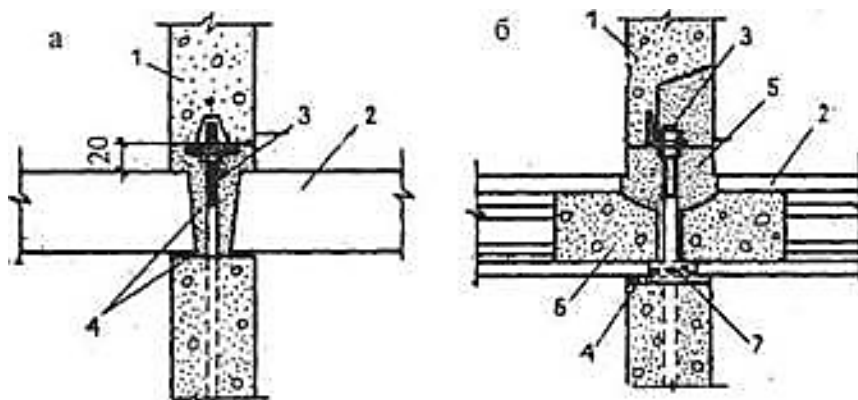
Платформенный стык на фиксаторах: а – с панелями перекрытий сплошного сечения; б – с многопустотными настилами; 1 – панель стены; 2 – панель перекрытия; 3 – фиксатор; 4 – цементный раствор (или паста); 5 – бетон замоноличивания; 6 – бетонные пробки в пустотах панели перекрытия; 7 – стык арматурных выпусков перекрытия.
